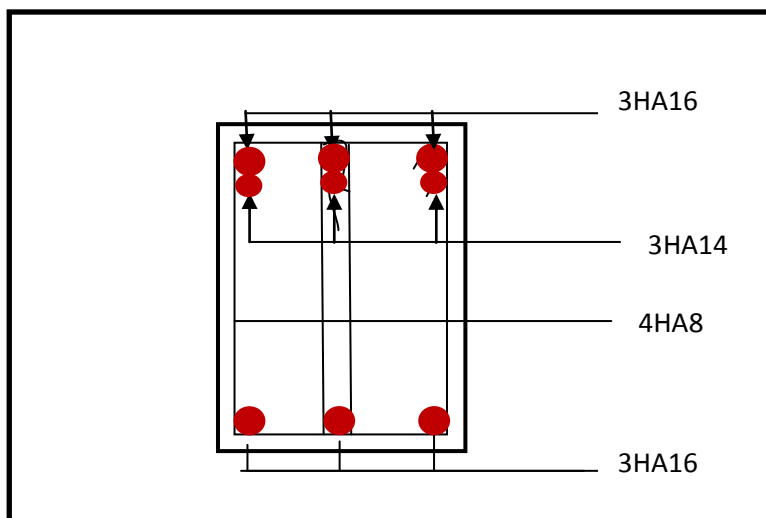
Ferrailage sur appuis d'une poutre principale.
